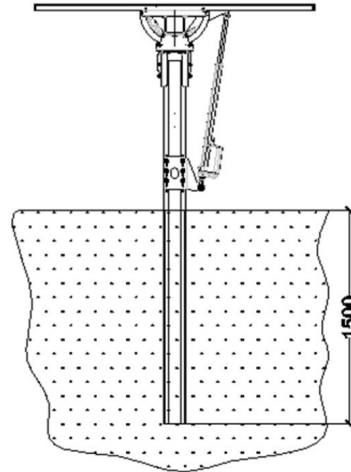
TIPO E LUNGHEZZA DI INFISSIONE
